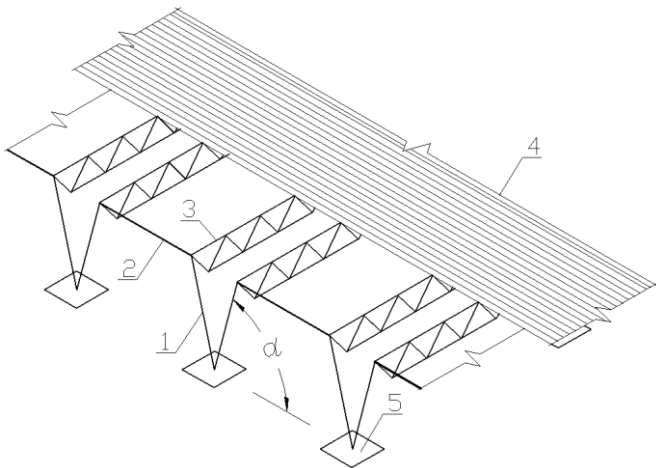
Фрагмент стального каркаса многопролетного здания.
